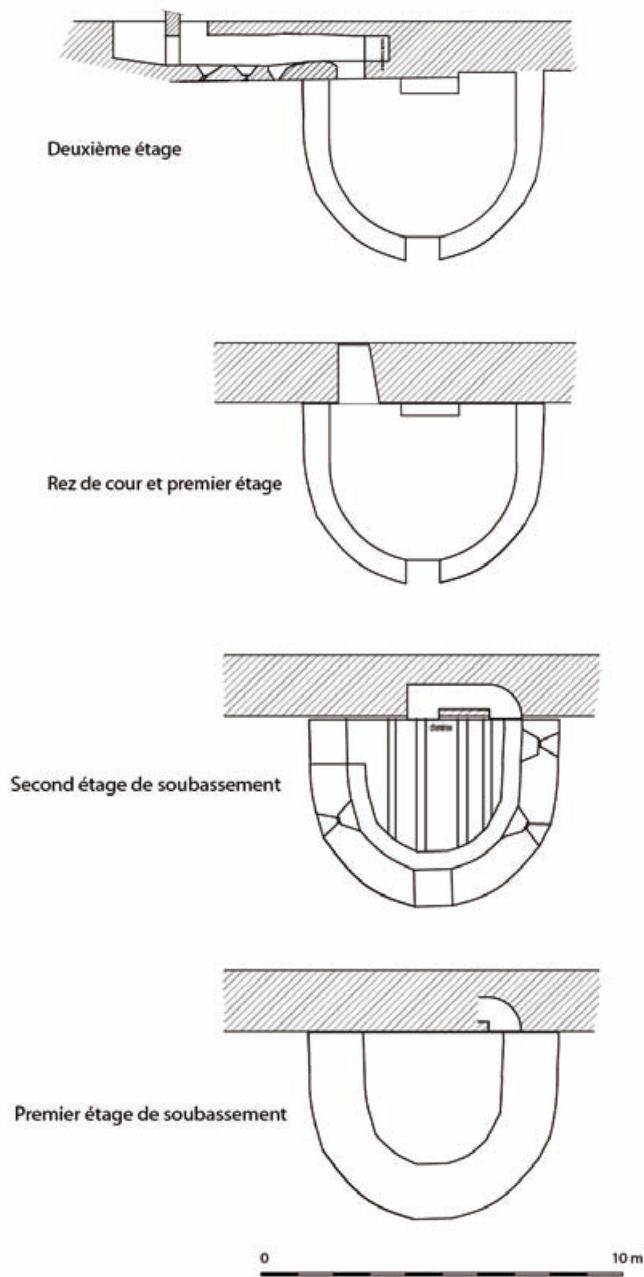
plans par étage de la tour (dessin P. Lhomme)
